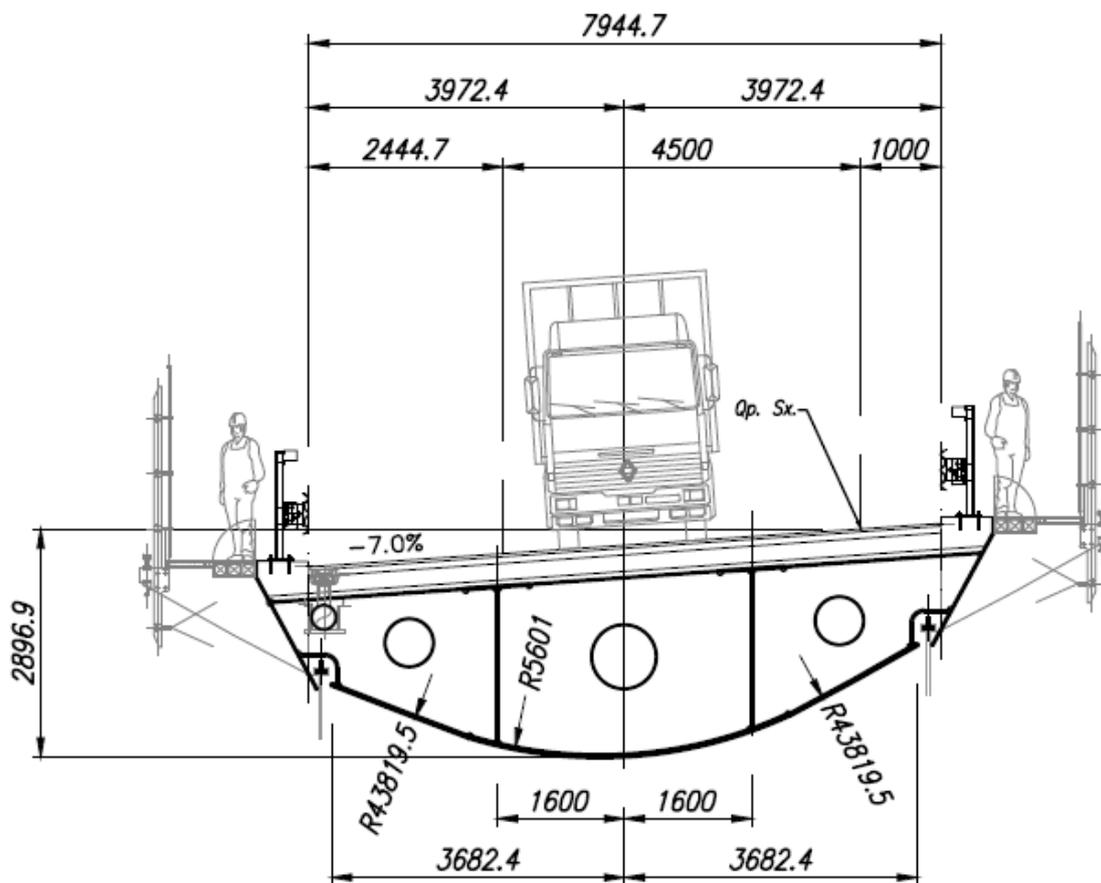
Sezione trasversale rampa di uscita dalla A7 (provenienza Milano)
